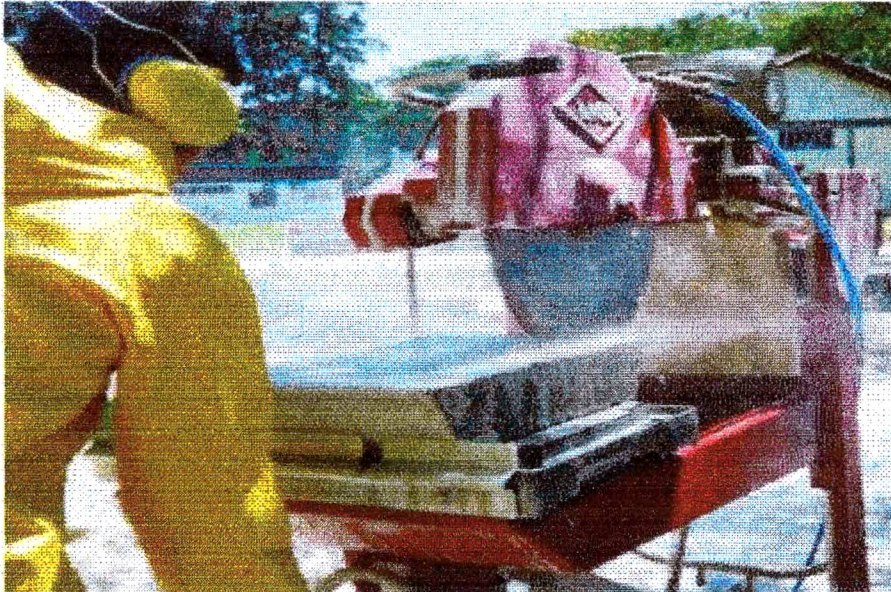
Corte de placas quadradas, moldadas especialmente para a extração de corpos de prova prismáticos (vigas), para ensaio de flexão.
